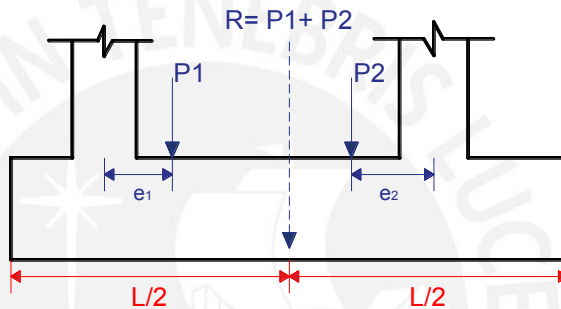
ZAPATAS COMBINADAS CON COLUMNAS EXCÉNTRICAS.
